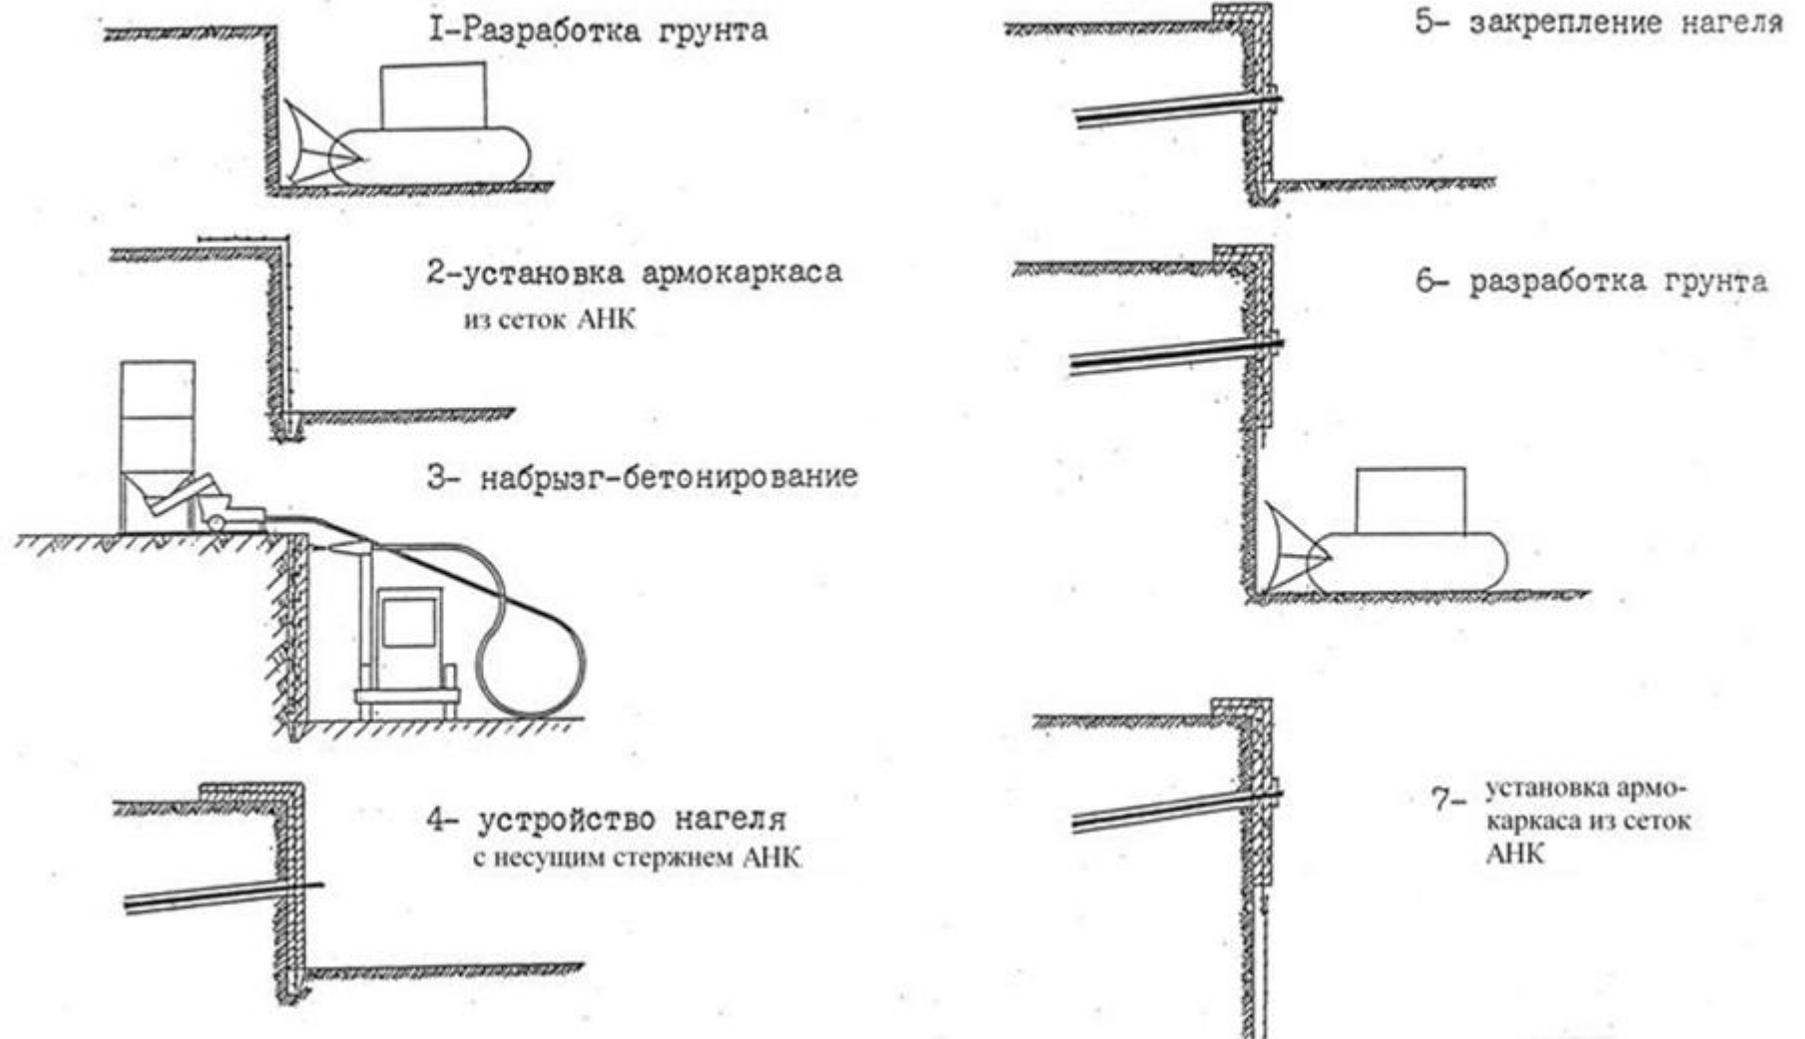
Технология устройства нагельного крепления с набрызг-бетонным экраном и буриноинъекционным нагелем с несущим стержнем АНК
